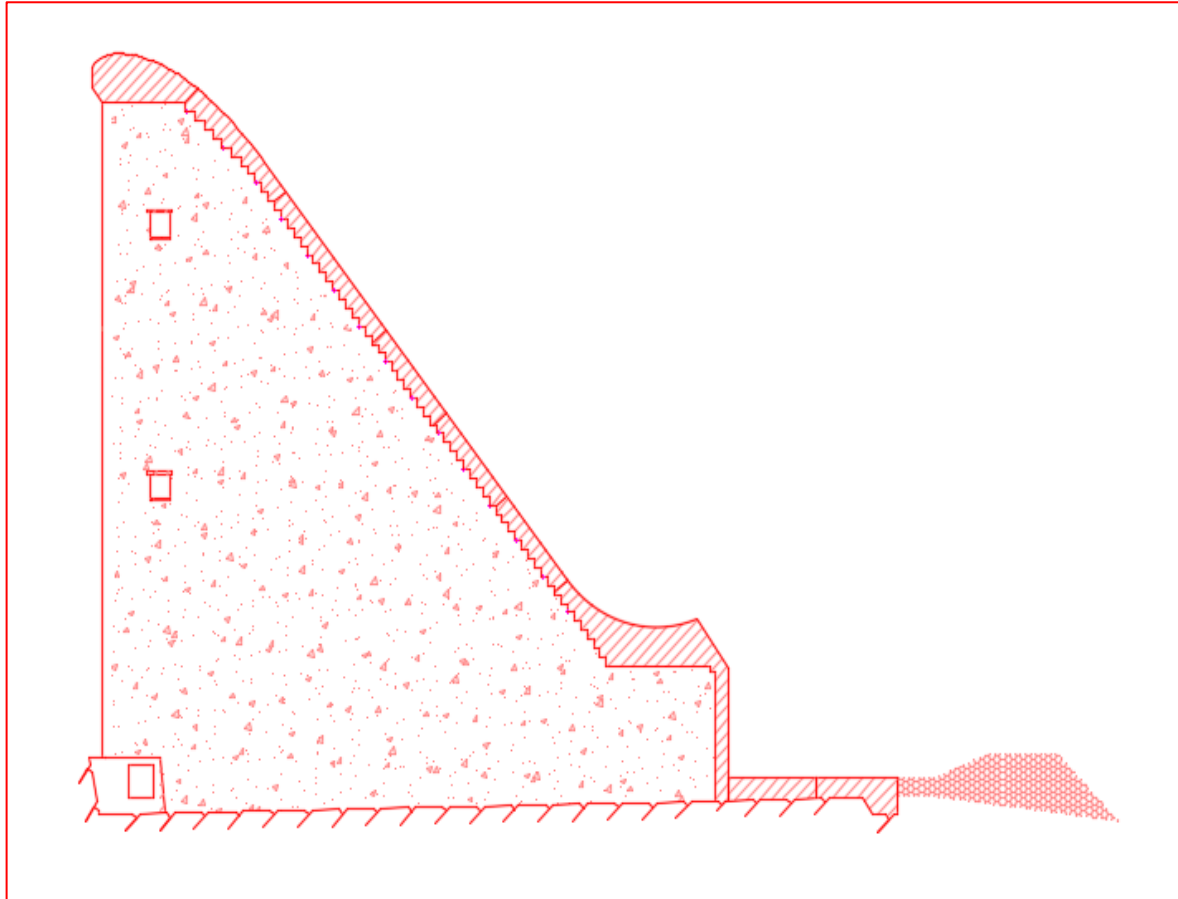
Coupe transversale du barrage de Béni-Haroun au niveau de l'évacuateur de crue
